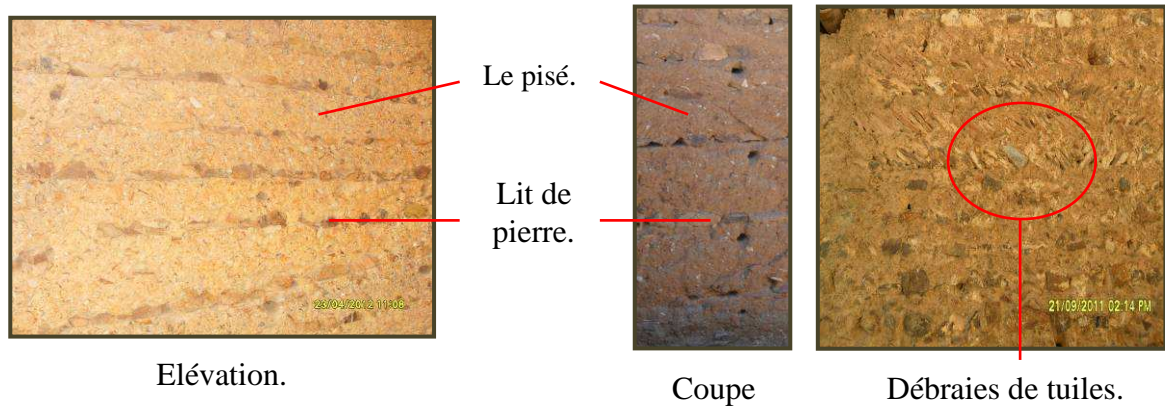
Mur en terre banchée, Maatkas (Source : Auteur).
